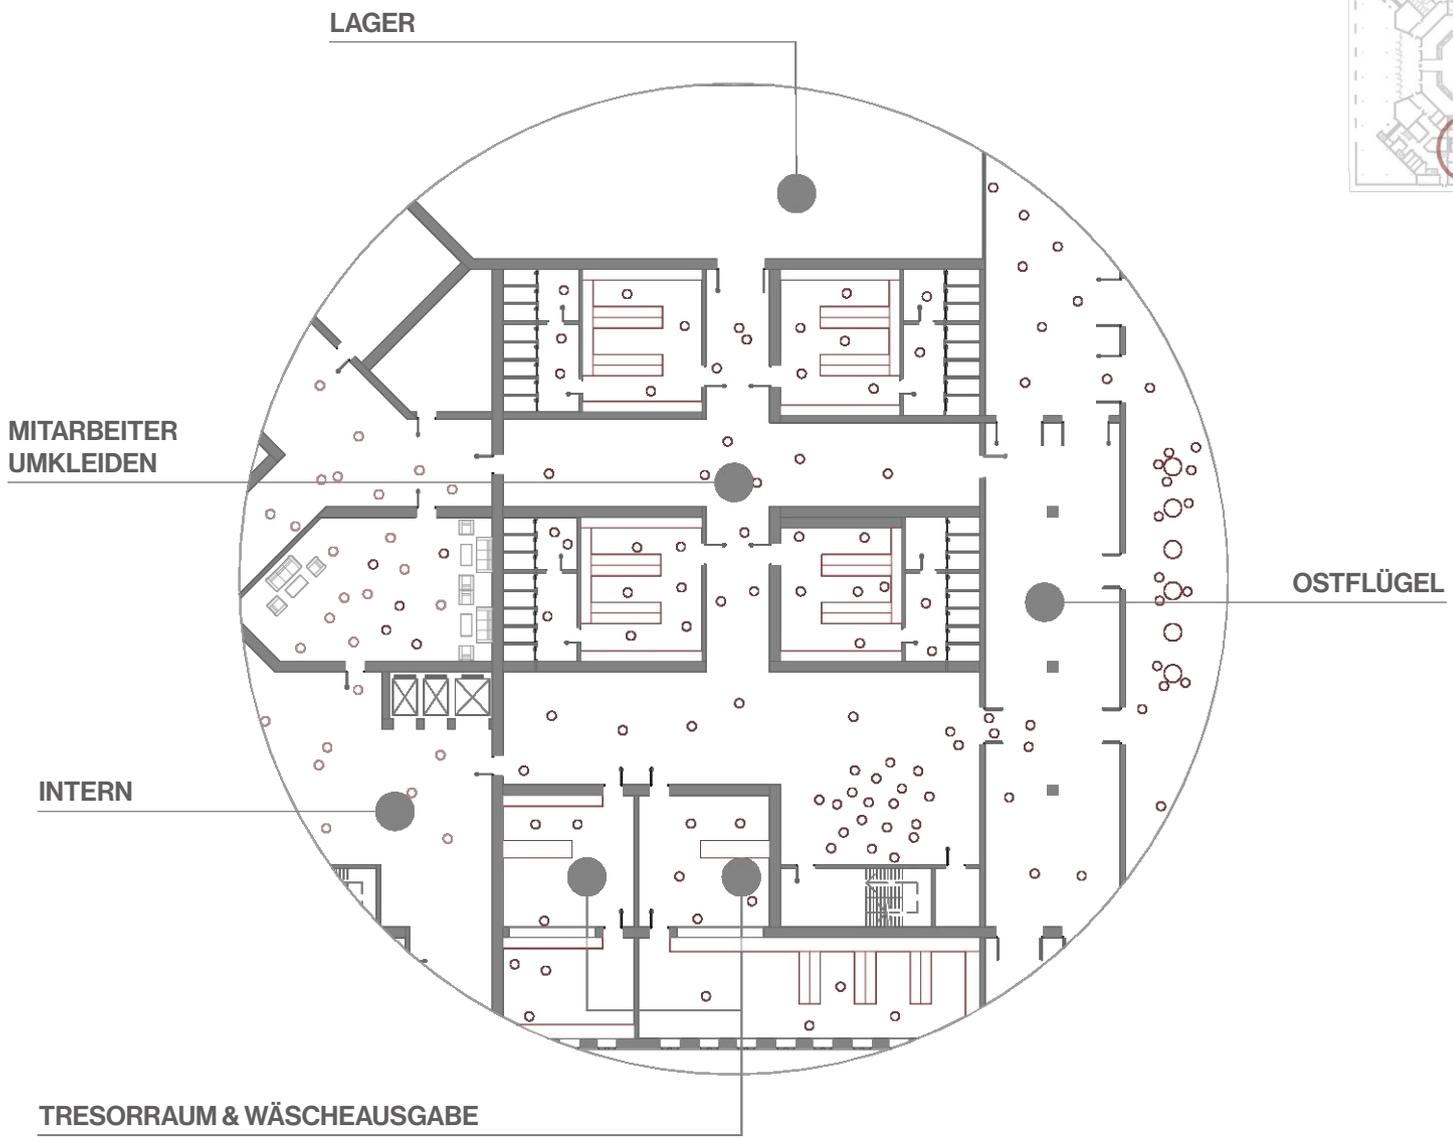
Grundriss EG Zoom Westflügel 2
